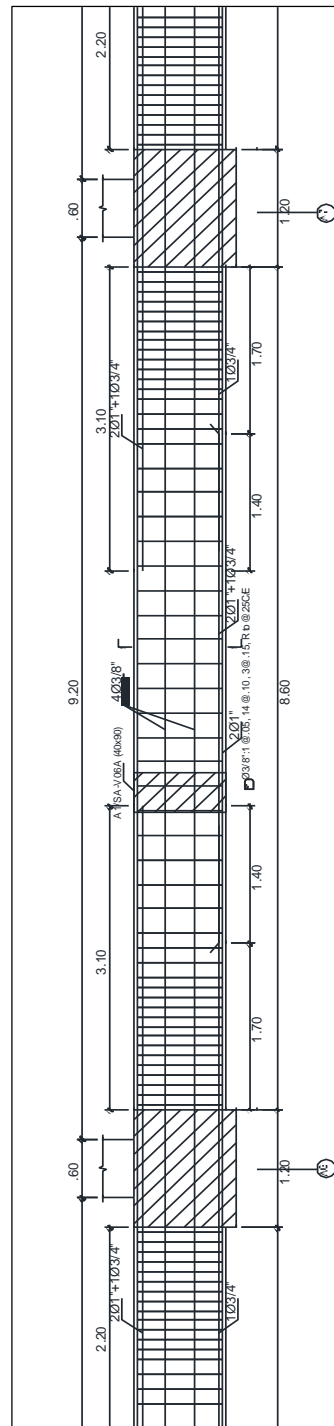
Detalle de reforzamiento de viga calculada (A1/SA-V02 (40x90))
